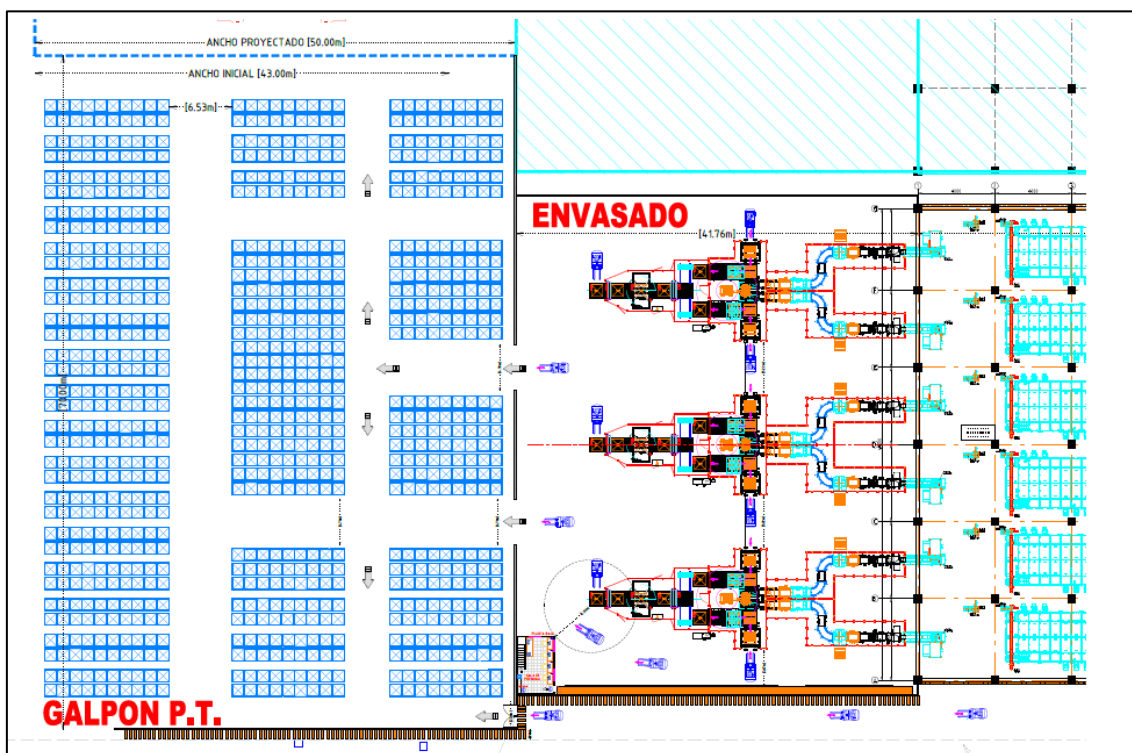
Vista de Planta – Sección de Envasado y Almacén de Tránsito.
